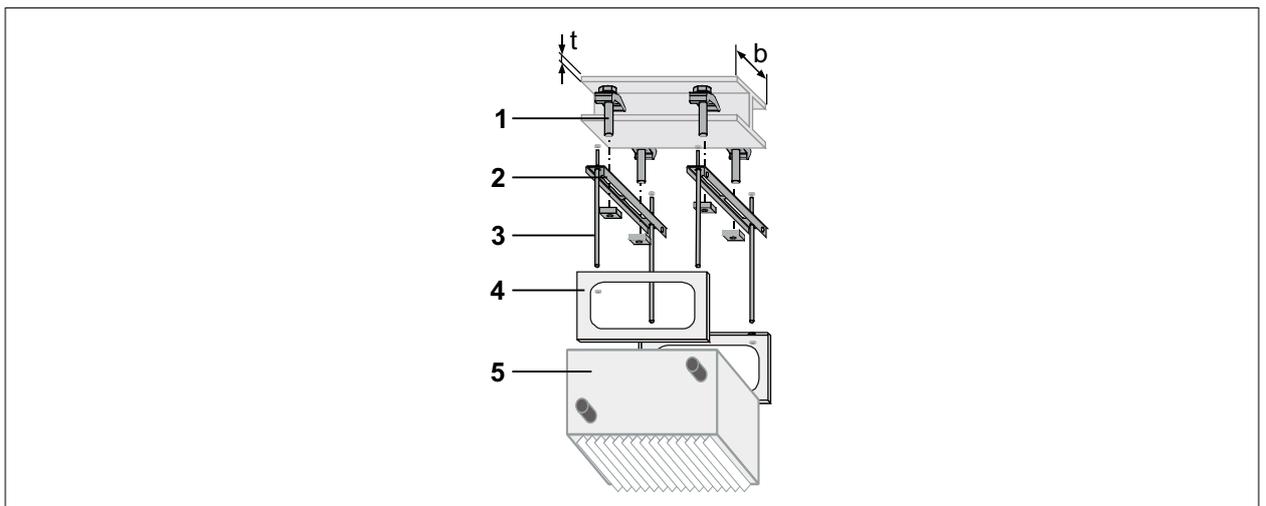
Montaje del aerotermo descolgado en la viga de acero
